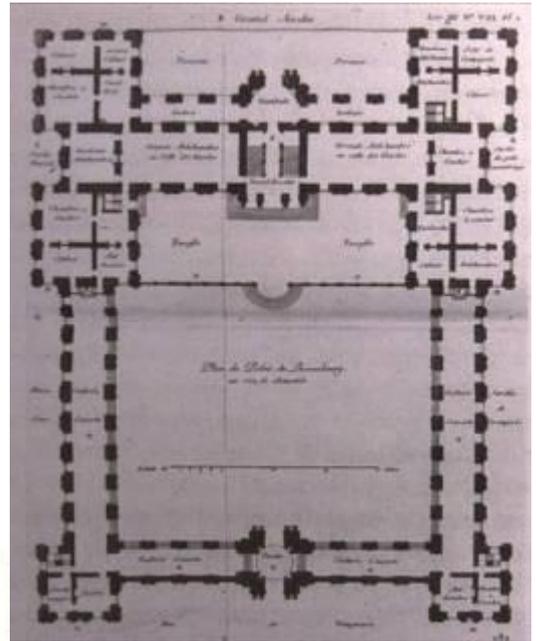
Palais du Luxembourg, Grundrissplan
